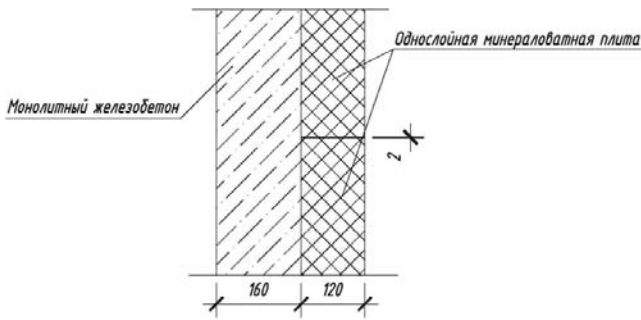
Узел № 1. Учёт зазора в теплоизоляции шириной 2 мм с основанием из монолитного железобетона. Вариант 1
